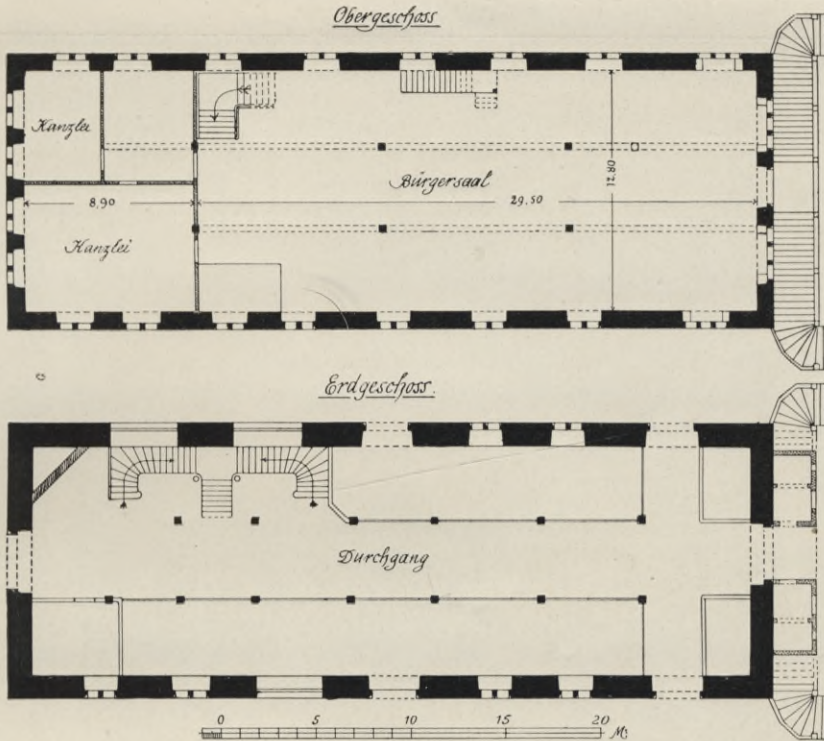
Karlstadt. Grundrisse des Rathauses.
